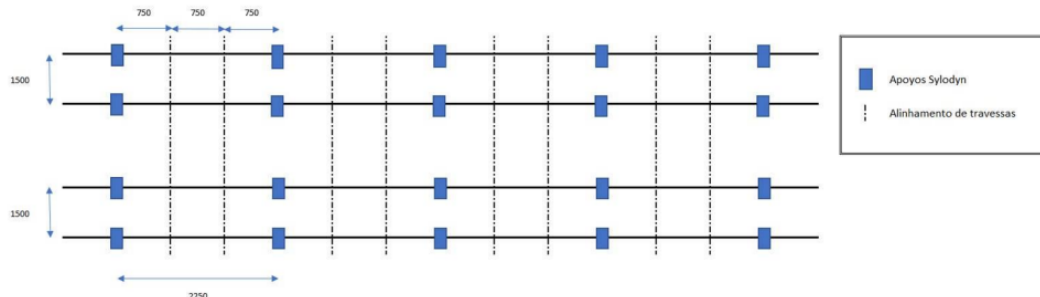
Esquema da posição dos apoios (*pot bearings*) de suporte da laje de via (desenho disponibilizado pelo fabricante)
